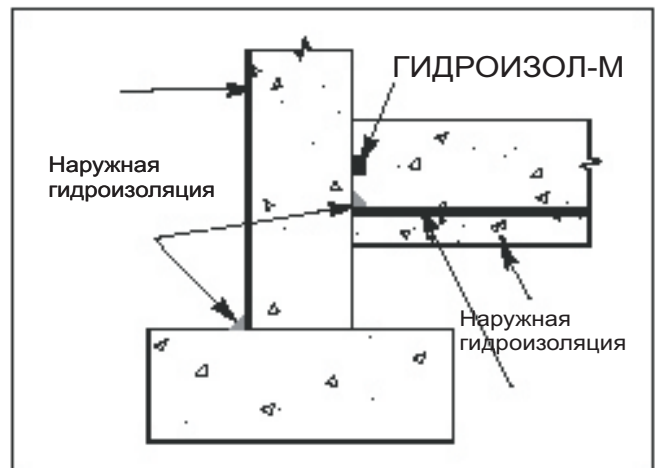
Монтаж шнура на лифтовых приямках без наружной гидроизоляции оголовка
